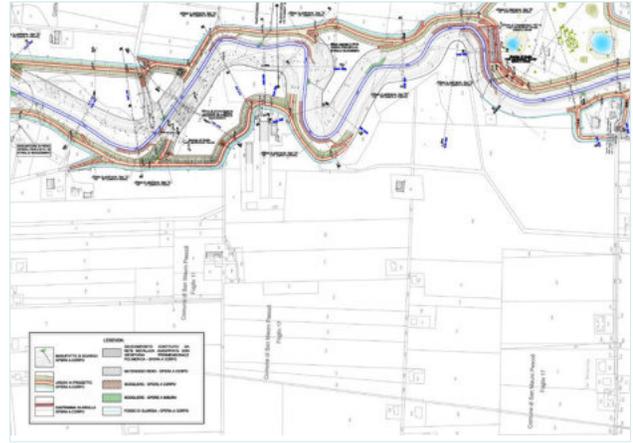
Progetto Uso 2014- 2° tratto Attraversamento CER
